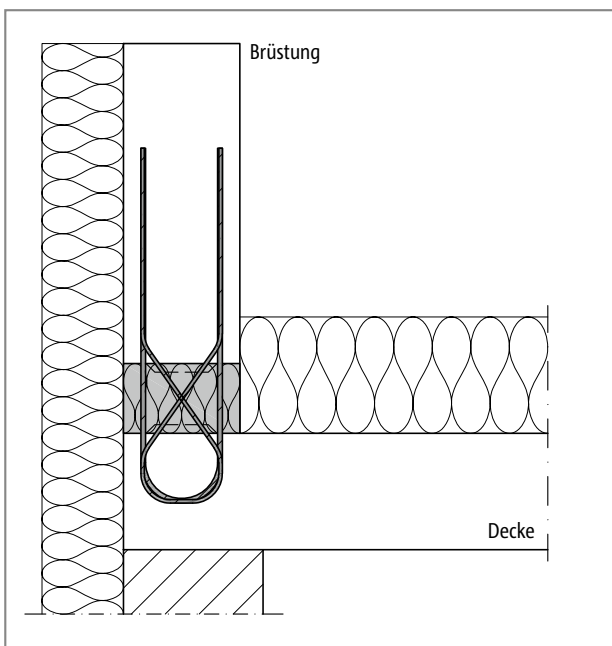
Schöck Isokorb® XT Typ AP vertikale Anordnung: Anschluss einer Attika
